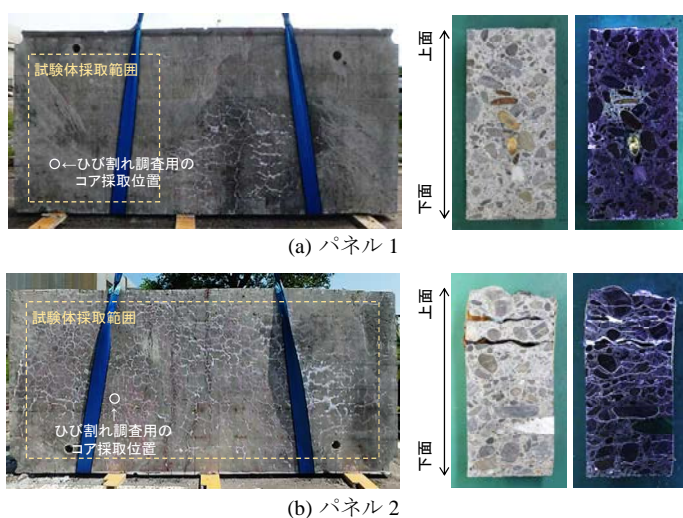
床版パネル(左：下面の状況、右：床版内のひび割れ状況)
